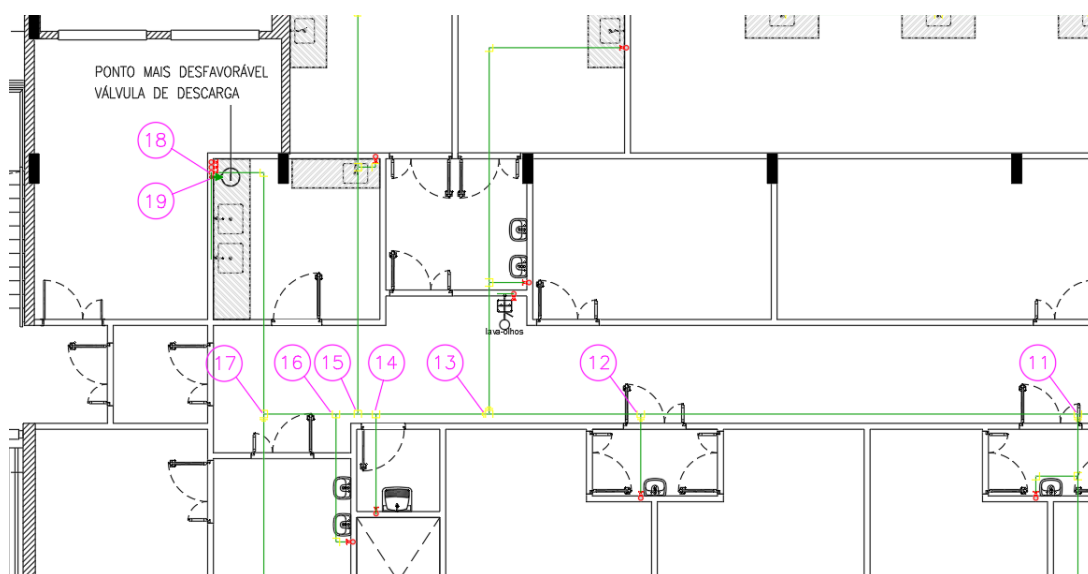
Trecho 2 (cont.) planta pavimento superior
